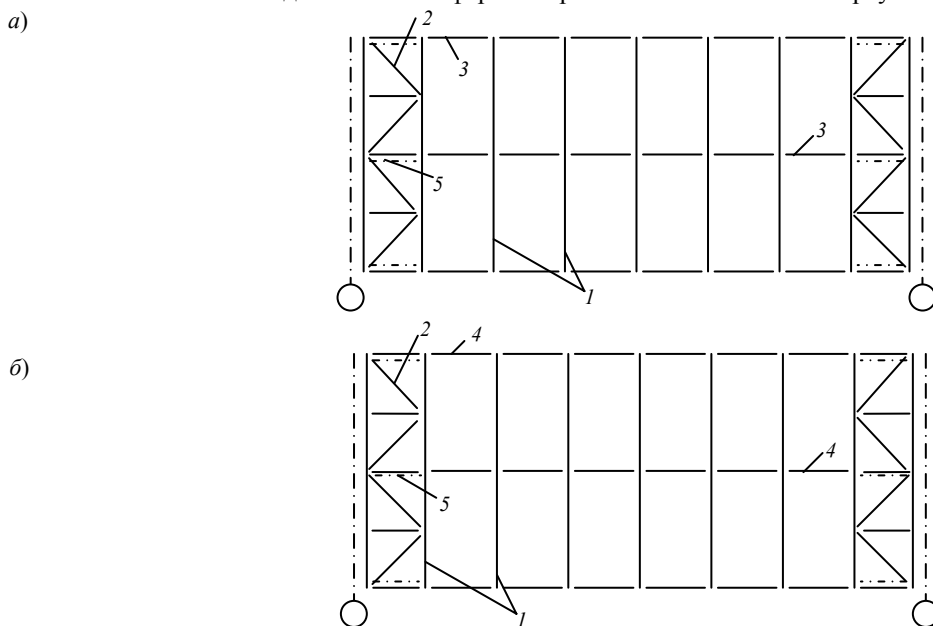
Схема связей по верхним (а) и нижним (б) поясам ферм:
